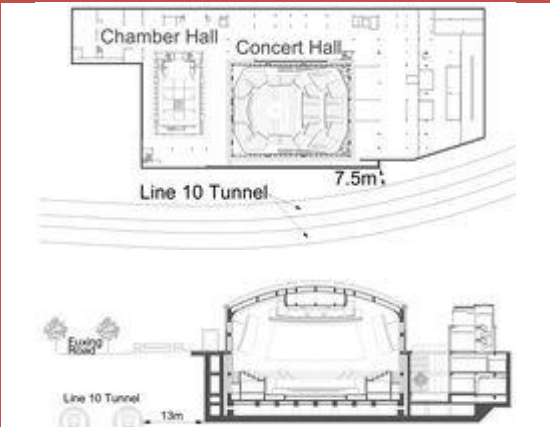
Planta y Sección Shanghai Symphony Hall
